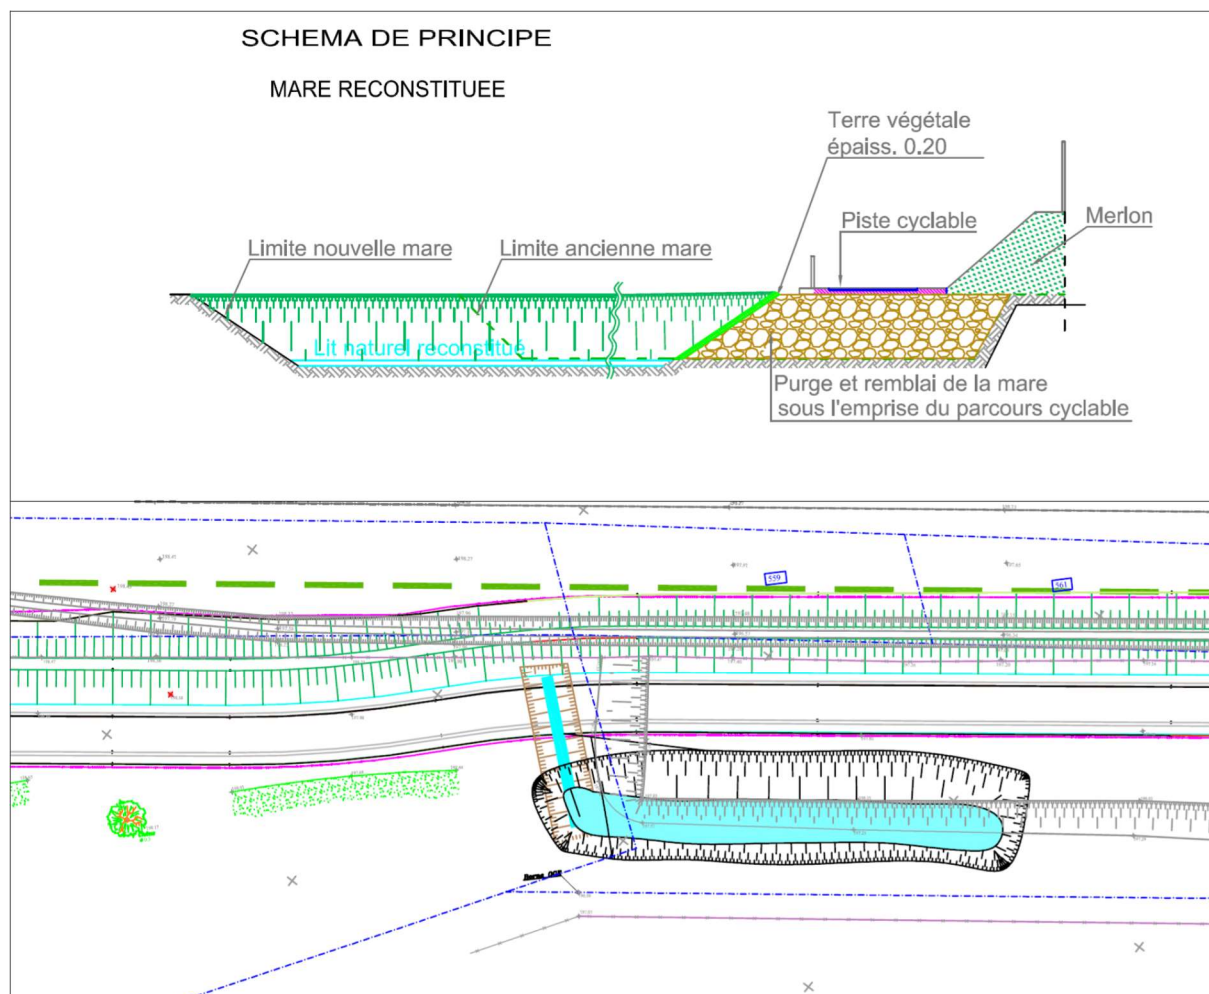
Coupes et plans du fossé en eaux à reconstituer
